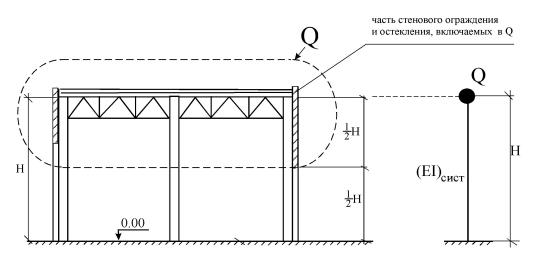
Формирование динамической расчетной схемы при жестком сопряжении стропильной конструкции с колоннами.
